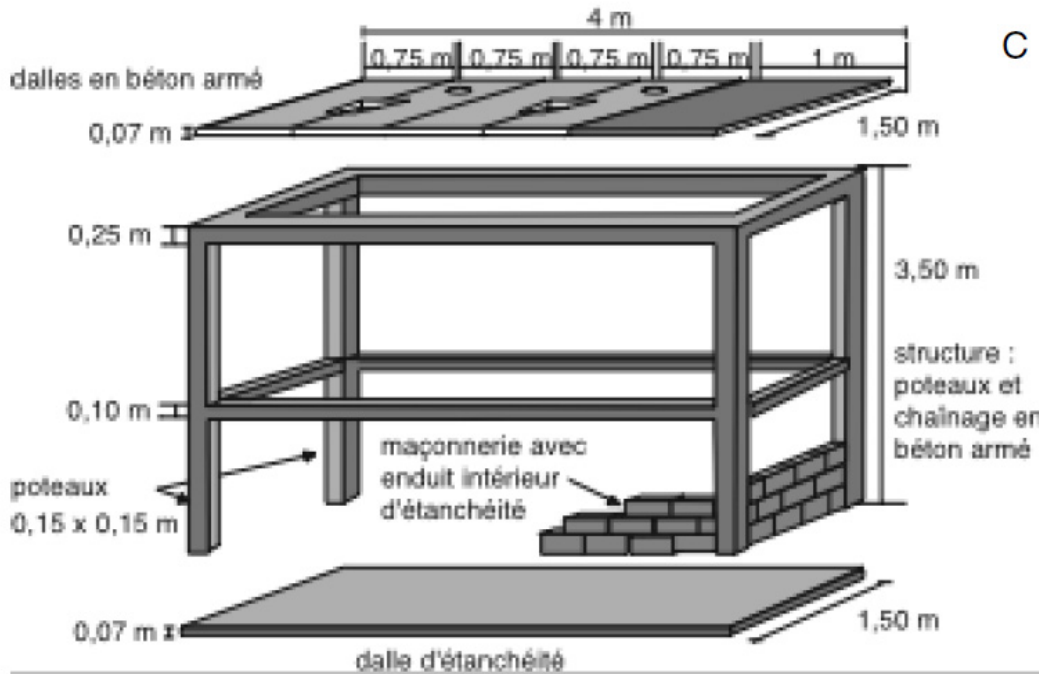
Fosse et fondations de toilettes à 2 postes. C : dalle sur maçonnerie étanche (ACF – 2006)
